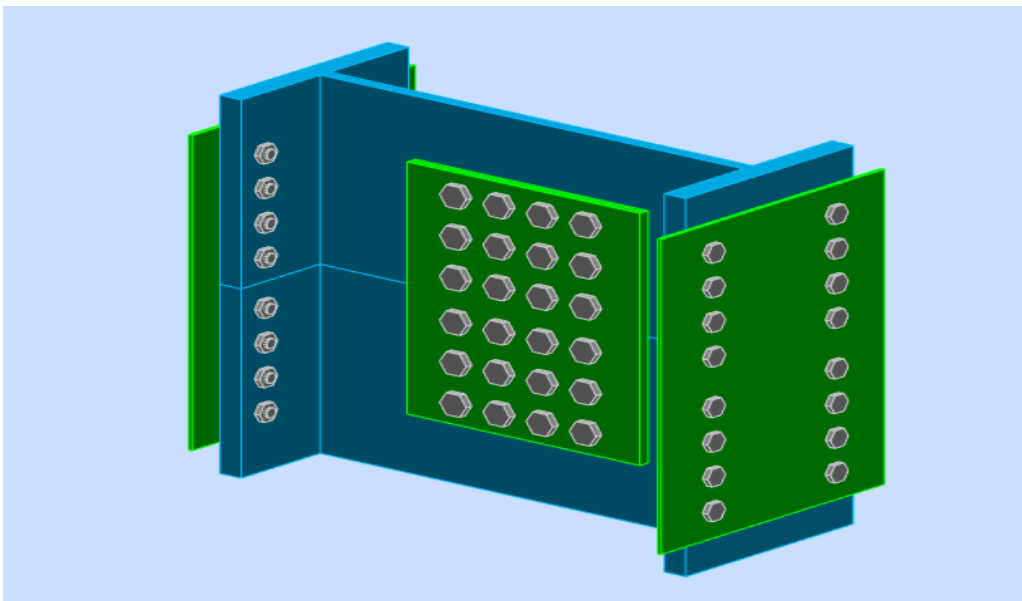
Assemblage poteaux – Poteaux (HEB700- HEB700).
